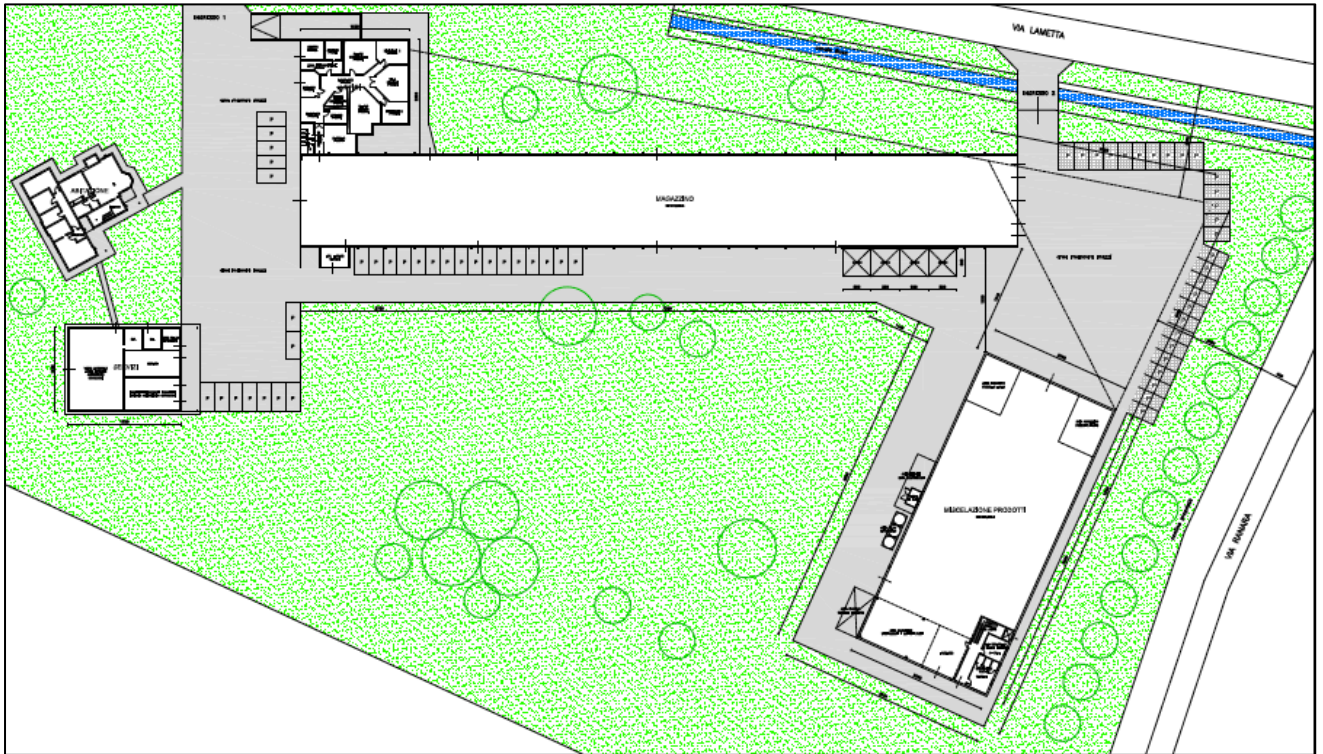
Planimetria stato di progetto (estratto tavola n.2 – progetto piante)
